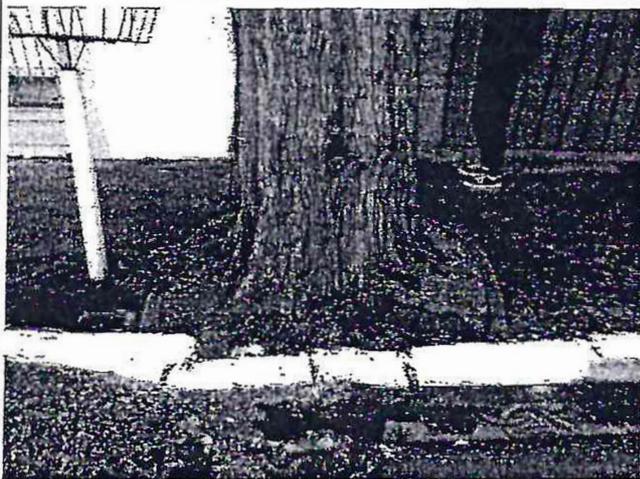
meio-fio abaulado pela raízes e crescimento em diâmetro da planta – árvore 2.
